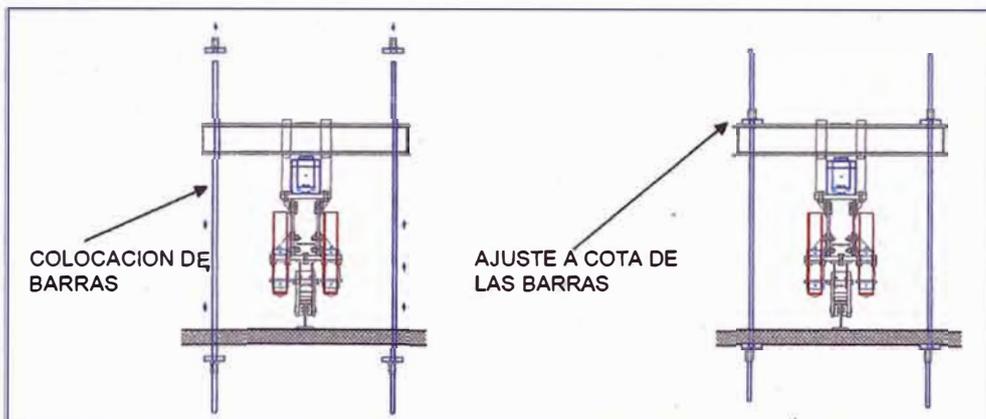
Tensado anclaje trasero - Fuente: Elaboración Propia
